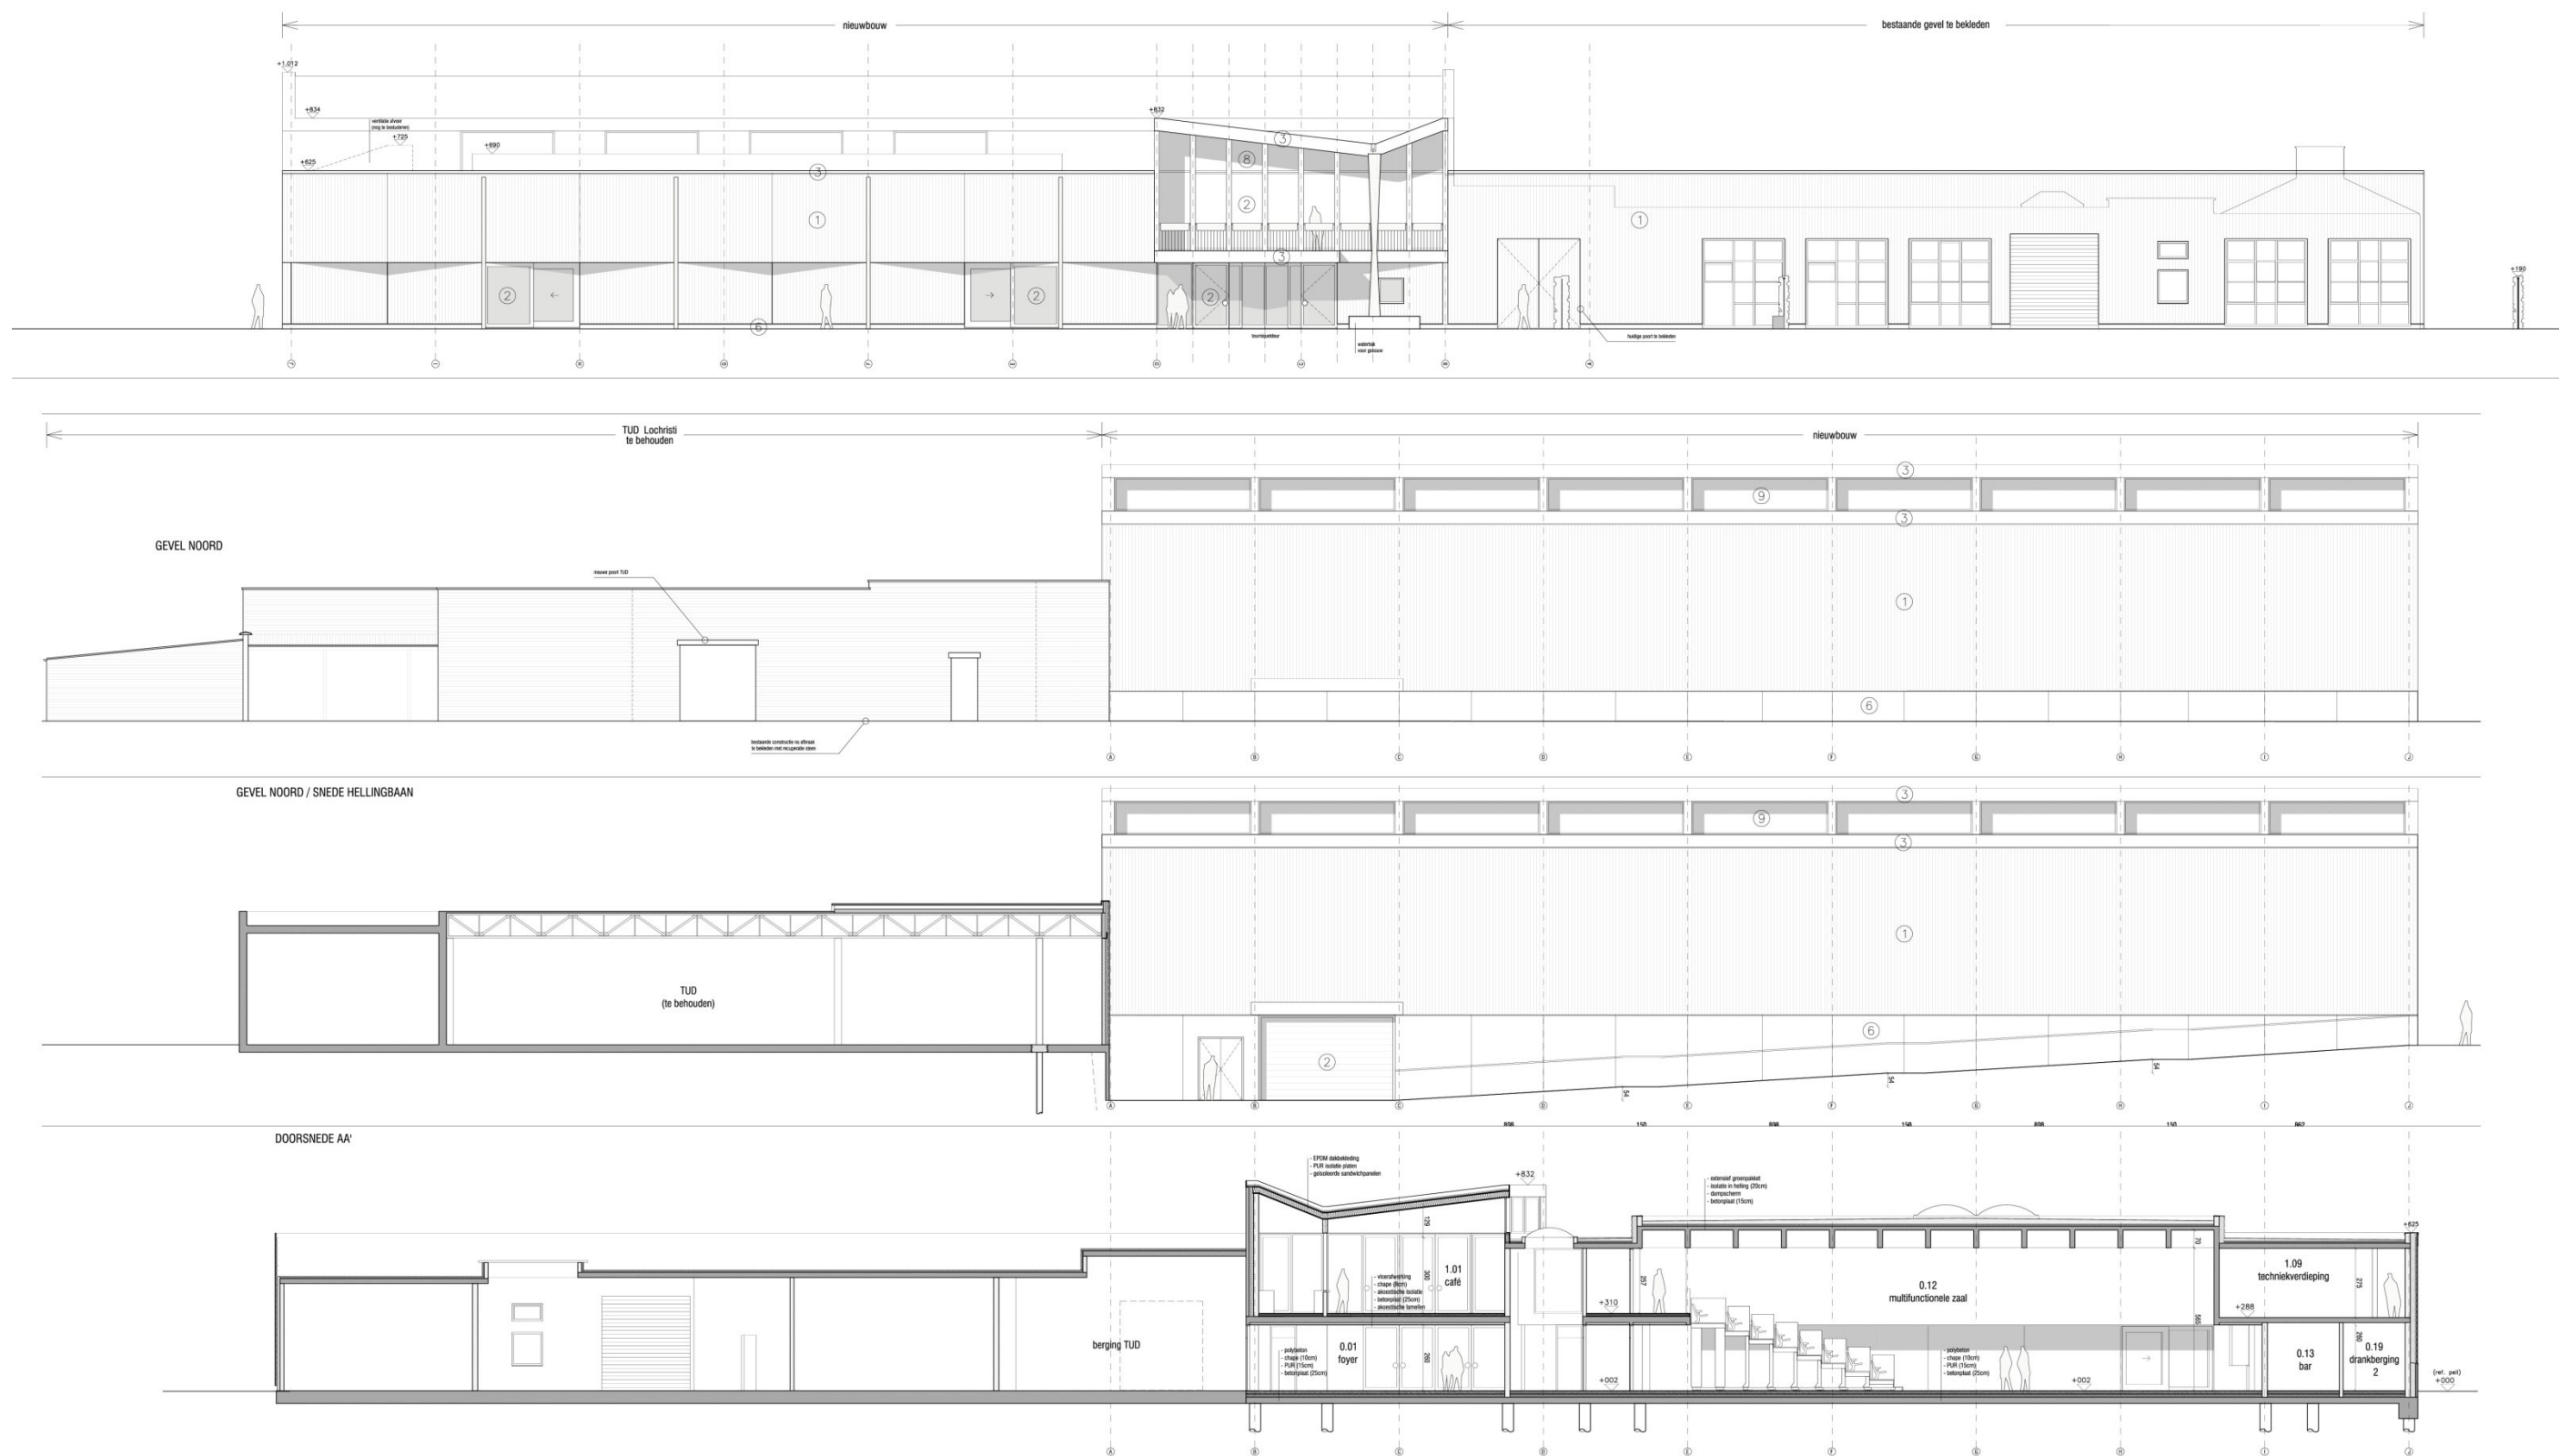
Zuid- en noordgevel, doorsnede AA' (BULK architecten).
